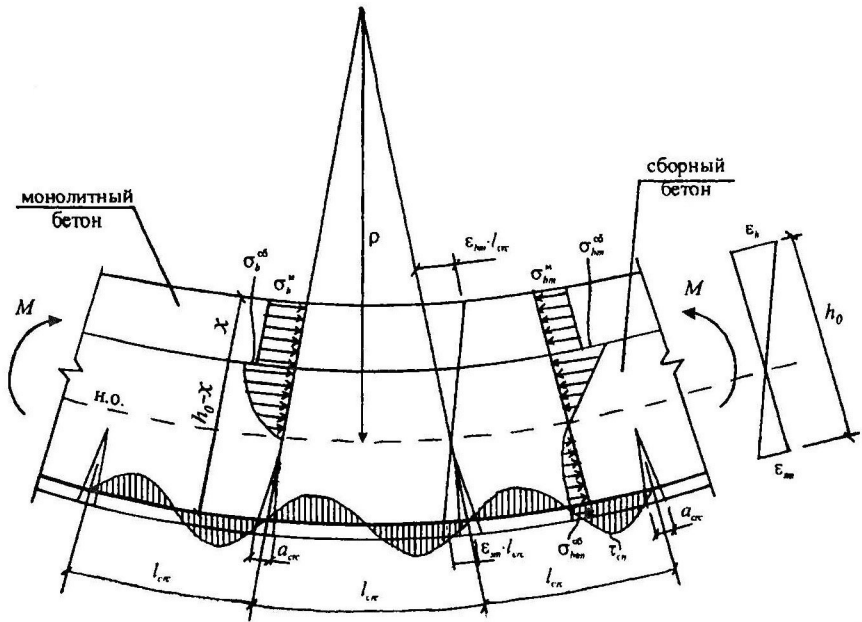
Напряженно-деформированное состояние сборно-монолитного железобетонного изгибаемого элемента после образования трещин (к расчету прогибов и ширины раскрытия трещин).
